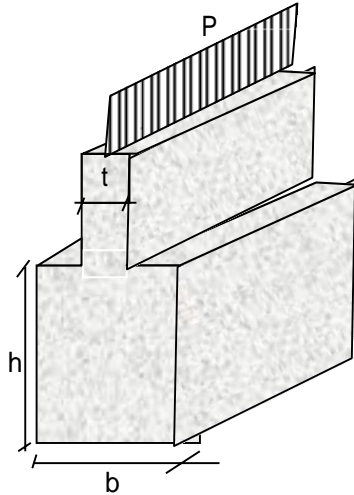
Diseño de viga de cimentación VC-02 en memoria de cálculo.
